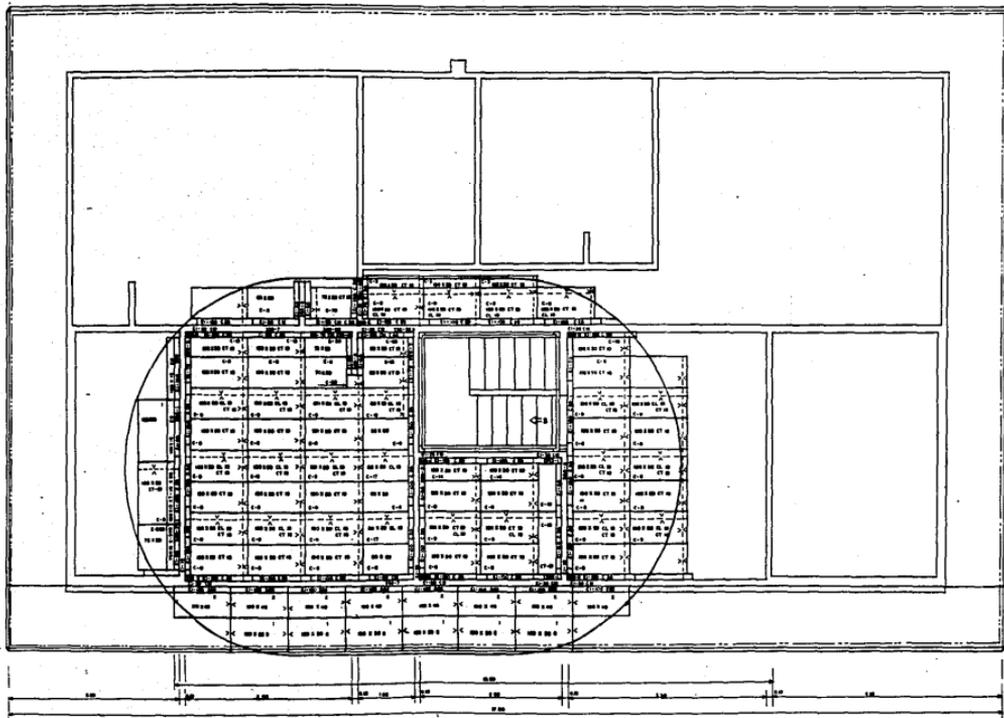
ARMADO ESTRUCTURAL Y COLOCACION DE
